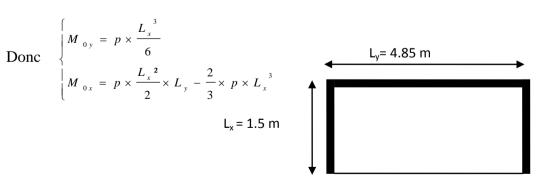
1^{er} type de Balcon sur trois appuis
